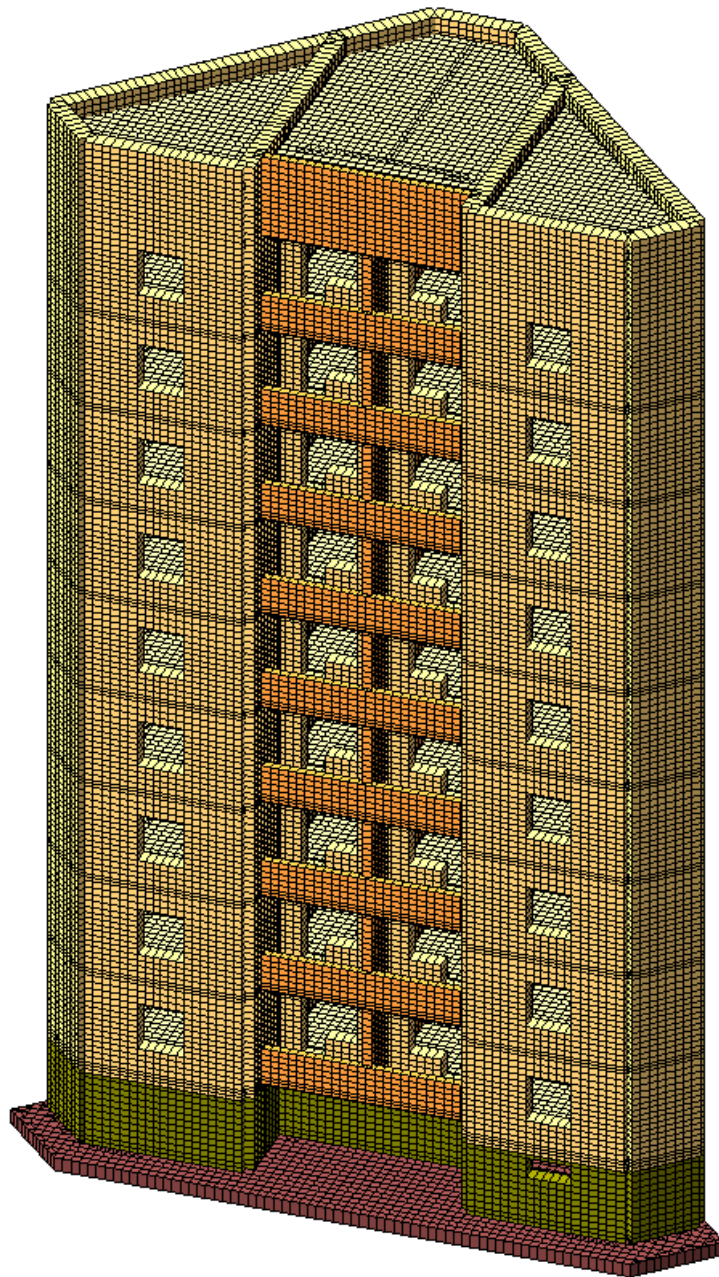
Розрахунок будівлі з урахуванням підсилення за схемою збільшення ширини фундаментної плити
